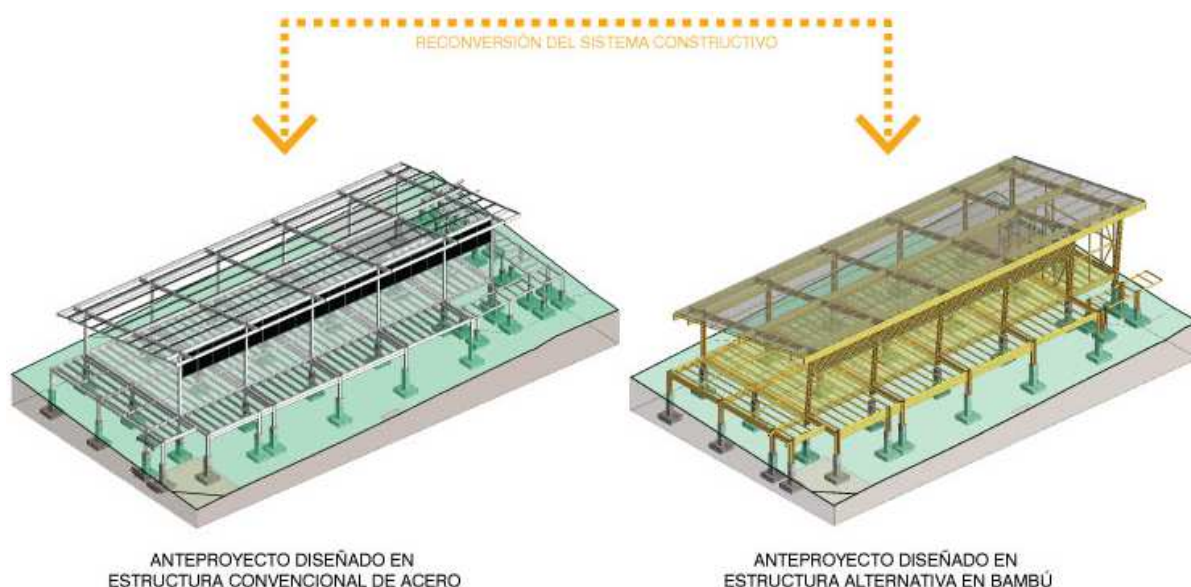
Diagrama de replanteamiento del sistema constructivo. Fuente: Elaborada por el autor.
